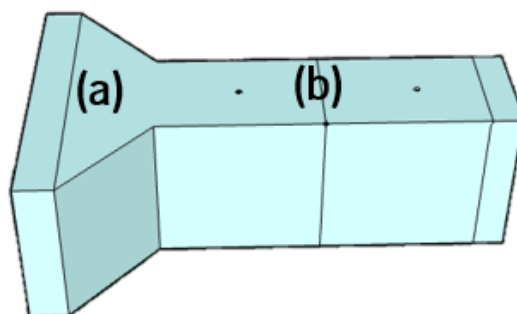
(a) secção trapezoidal; (b) Secção retangular
